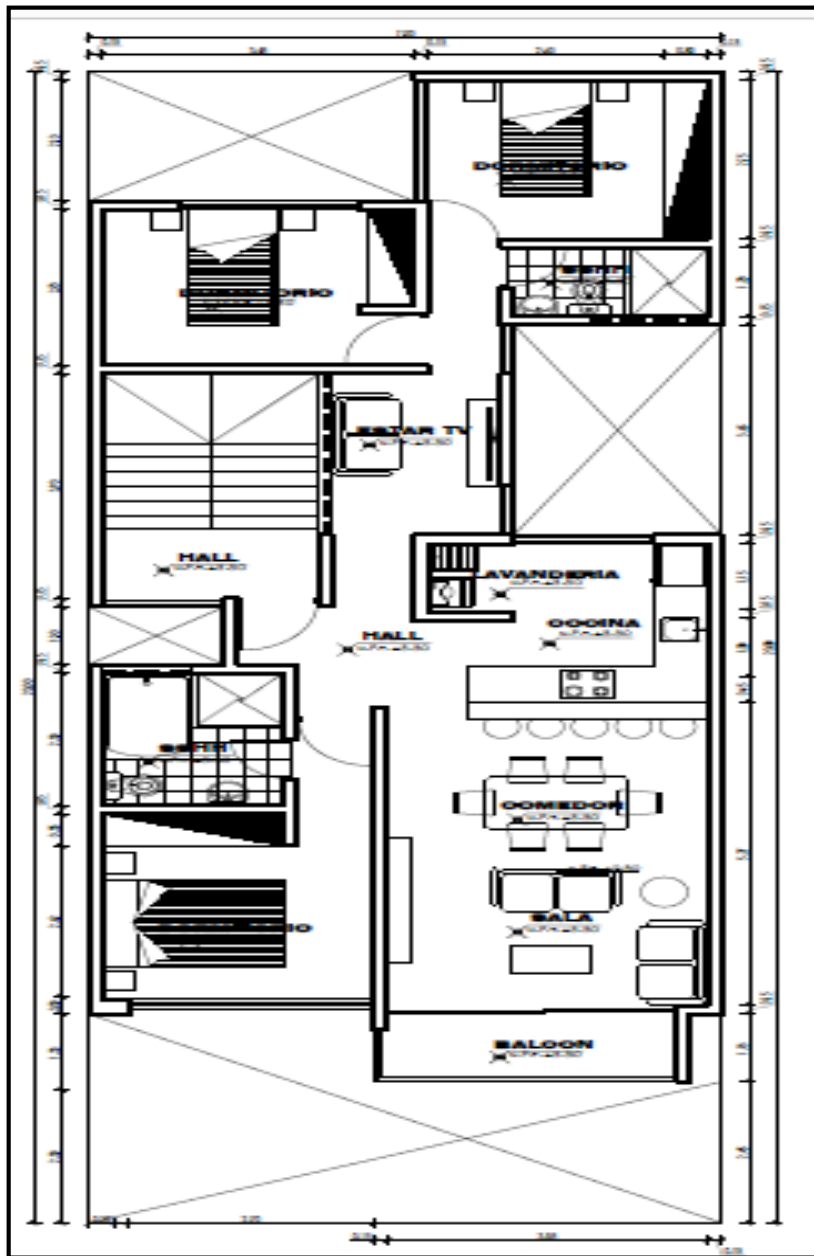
Plantas típicas 2°, 3°y 4° nivel
